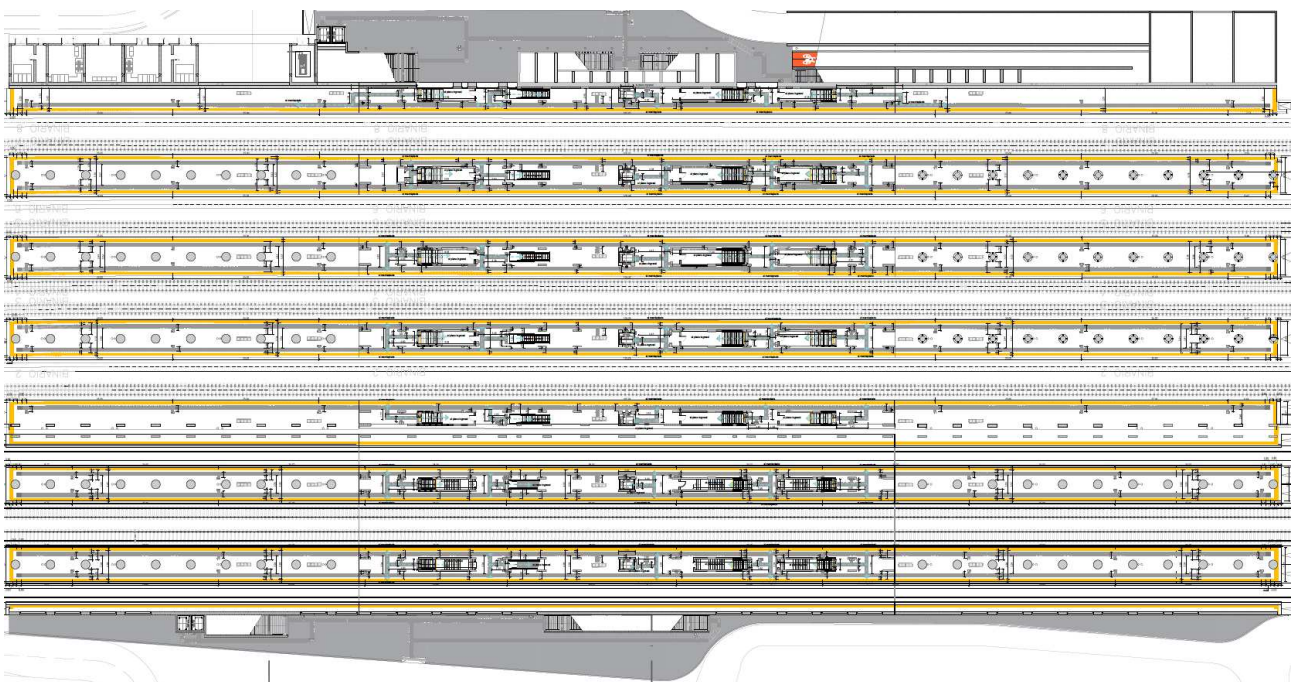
Planimetria percorsi tattili Piano Banchine.
